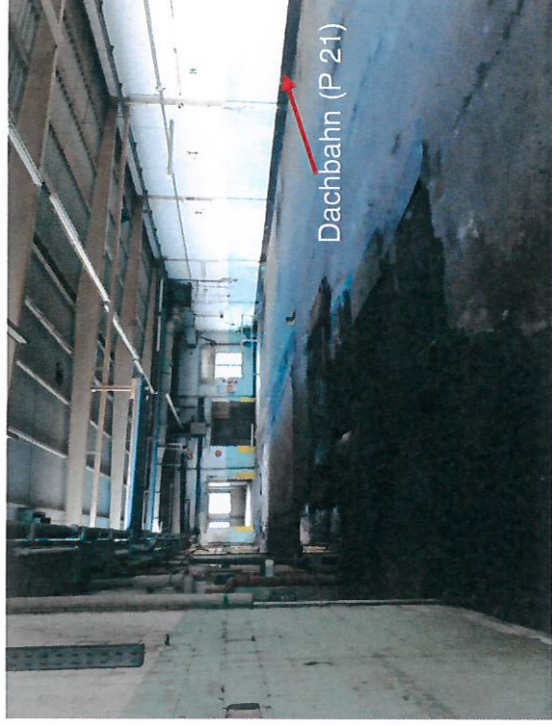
„alte Färberei“ (Appretur) mit Trapezblechdach
